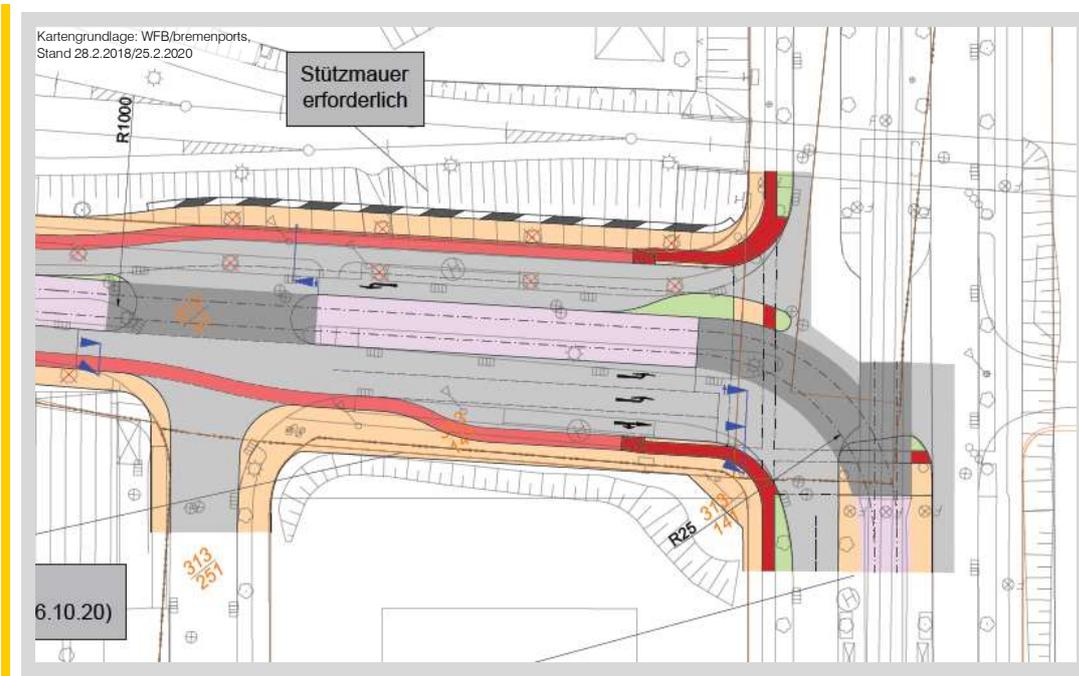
Ausschnitt Lageplan Knoten Konsul-Smidt-Straße/ Hansator
